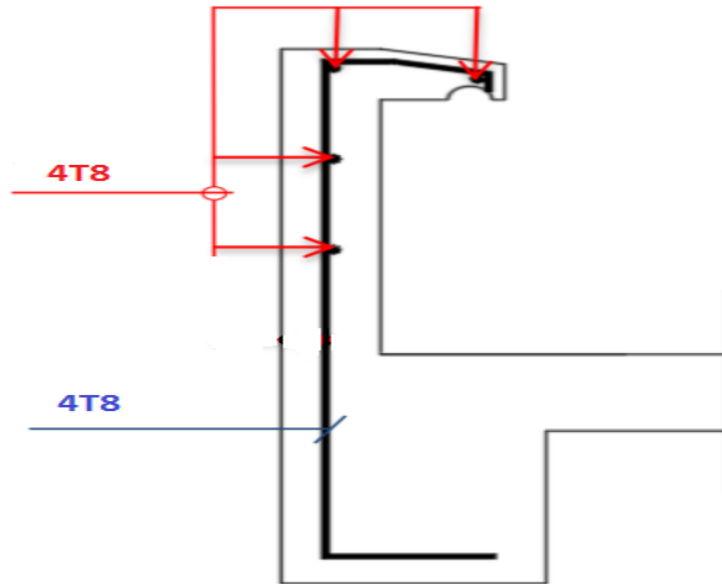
Schéma du Ferrailage de l'acrotère.
